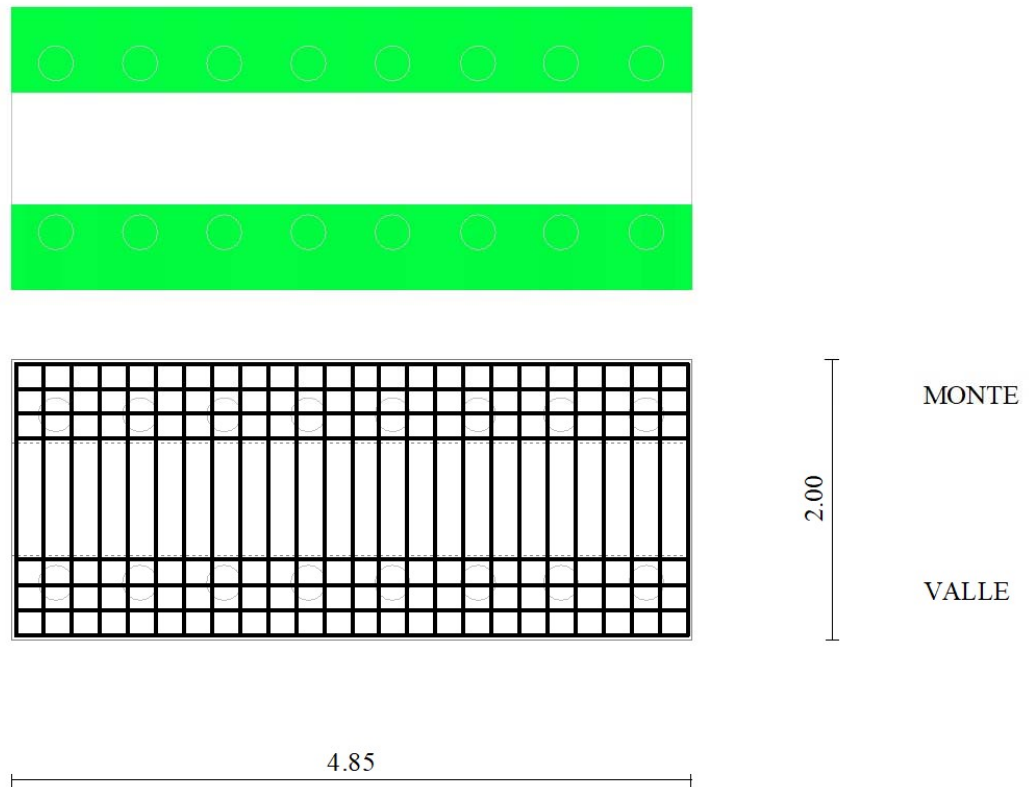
Piastra fondazione dir. X (Inviluppo)
